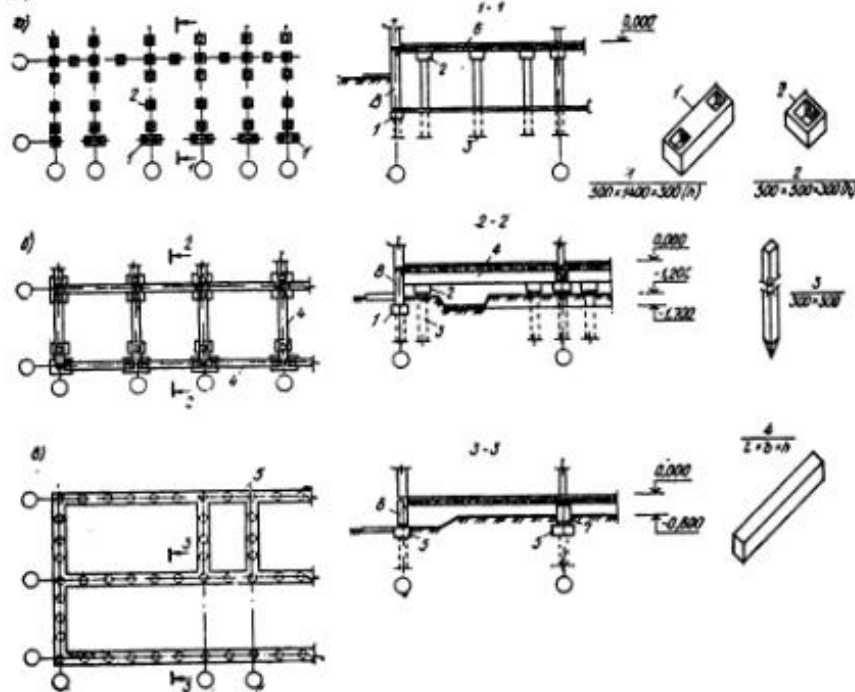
Свайные фундаменты панельных зданий: а - схема плана безростверкового фундамента со сборными оголовками; б - то же, со сборным ростверком; в - то же, с монолитным ростверком; 1, 2 - сборные оголовки; 3 - свая; 4 - сборный ростверк; 5 - монолитный ростверк; 6 - панель перекрытия; 7 - внутренняя цокольная панель; 8 - то же, наружная
